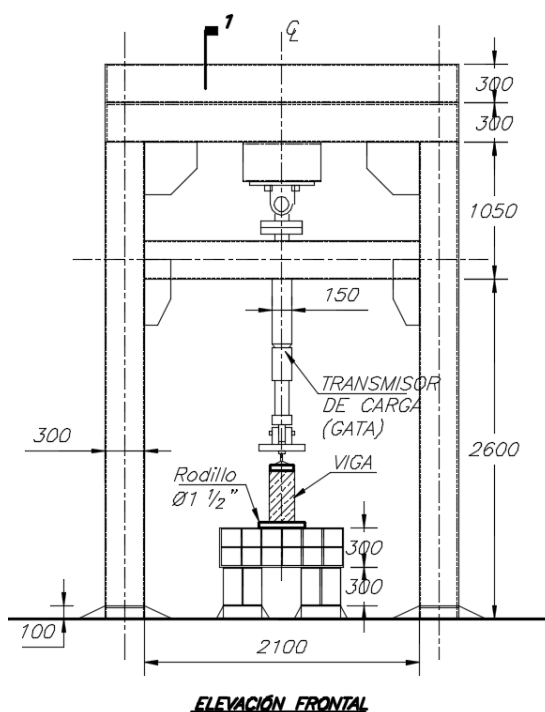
Elevación - configuración del Aparato de ensayo.
